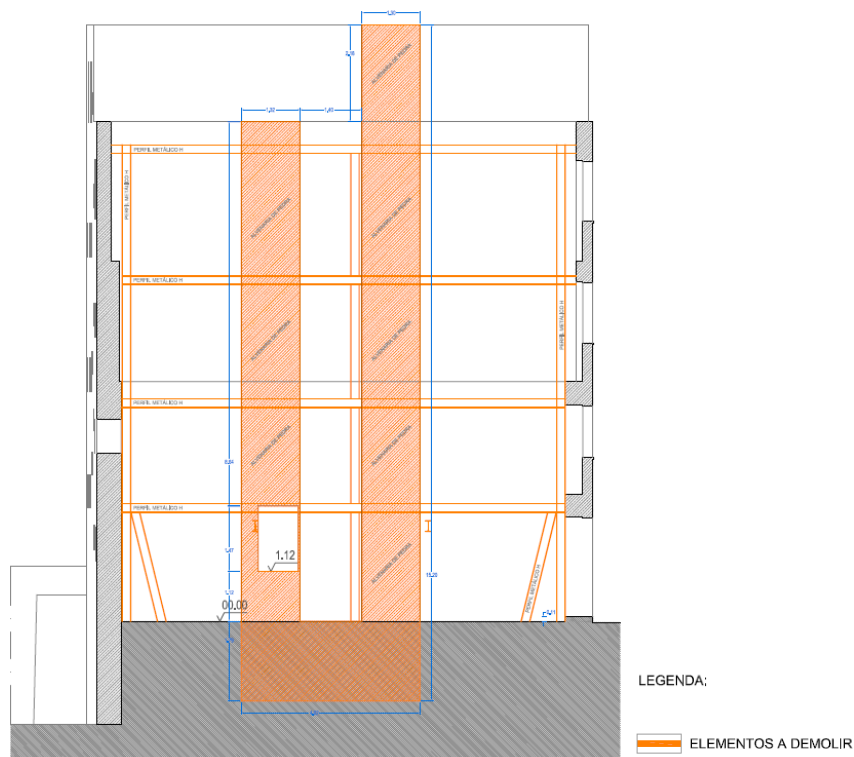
Corte C2 com elementos a demolir - Fonte: Desenhos de Arquitetura da Operação E2 - Projeto 9
